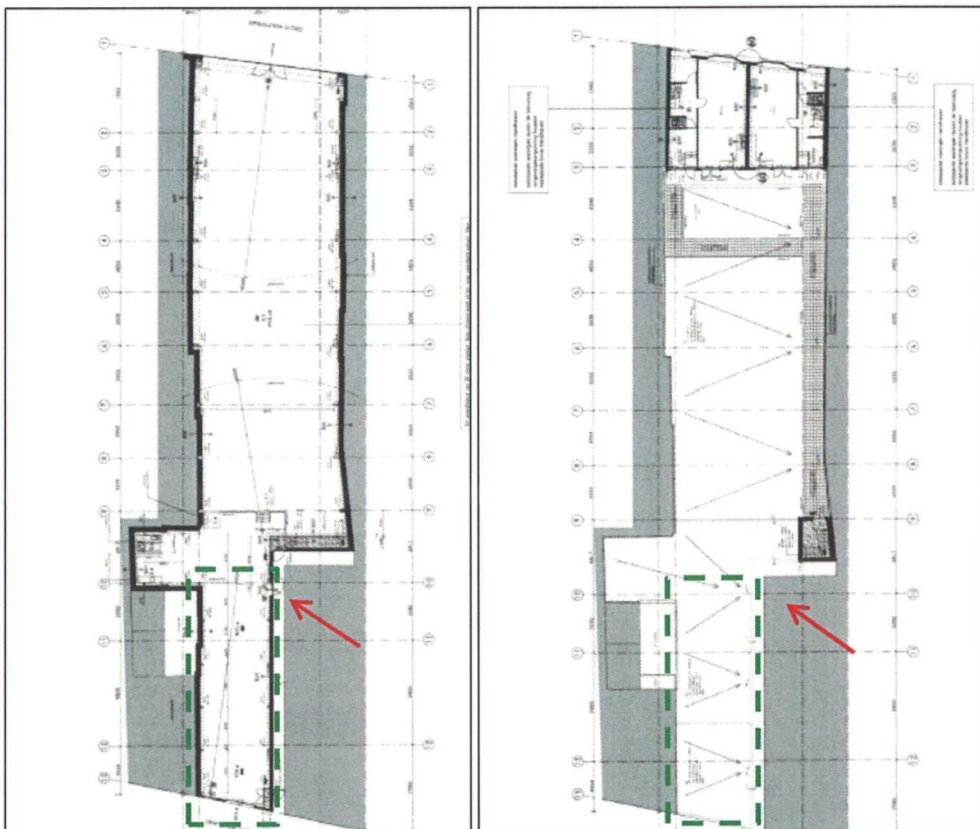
Bestaande bebouwing ten tijde van bestemmingsplan Heiliglanden - De Kamp
